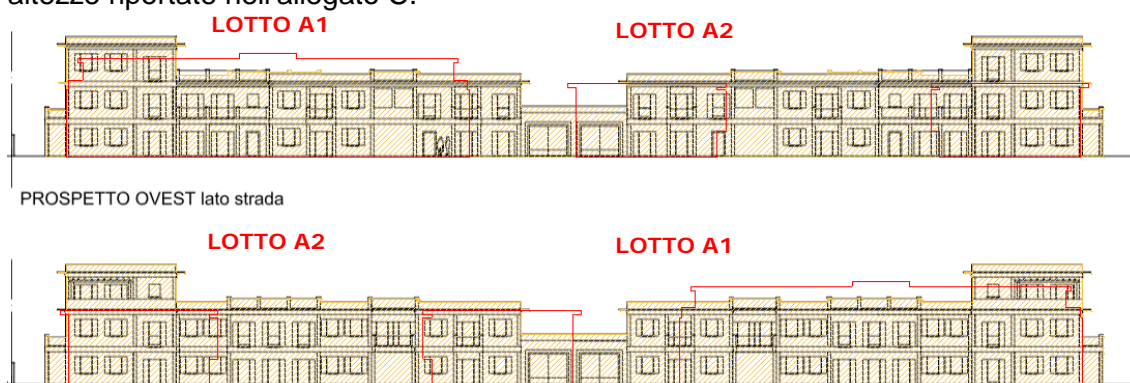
Allegato C – Parametri edilizi – in rosso è riportato il nuovo progetto
